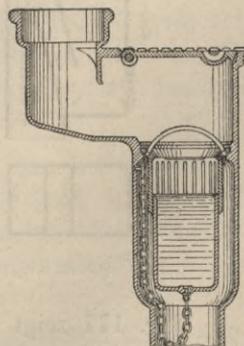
zeigt eine Anordnung von Geiger mit einem als Schlammfang dienenden Eimer. Diese Anlagen befinden sich sämtlich unter der Erde und sind ohne Wasserverschluss, um die Lüftung der Strafsenkanäle zu ermöglichen. Ein Abschlufs wird jedoch erforderlich, wenn das Regenrohr in der Nähe der Fenster bewohnter Räume mündet (in Wiesbaden, wenn die Mündung den Fenstersturz nicht mindestens 1 m überragt oder 2 m seitwärts vom Fenster absteht); er wird dann ähnlich gebildet, wie bei den Strafsen- und Hofeinläufen (Fig. 176).
